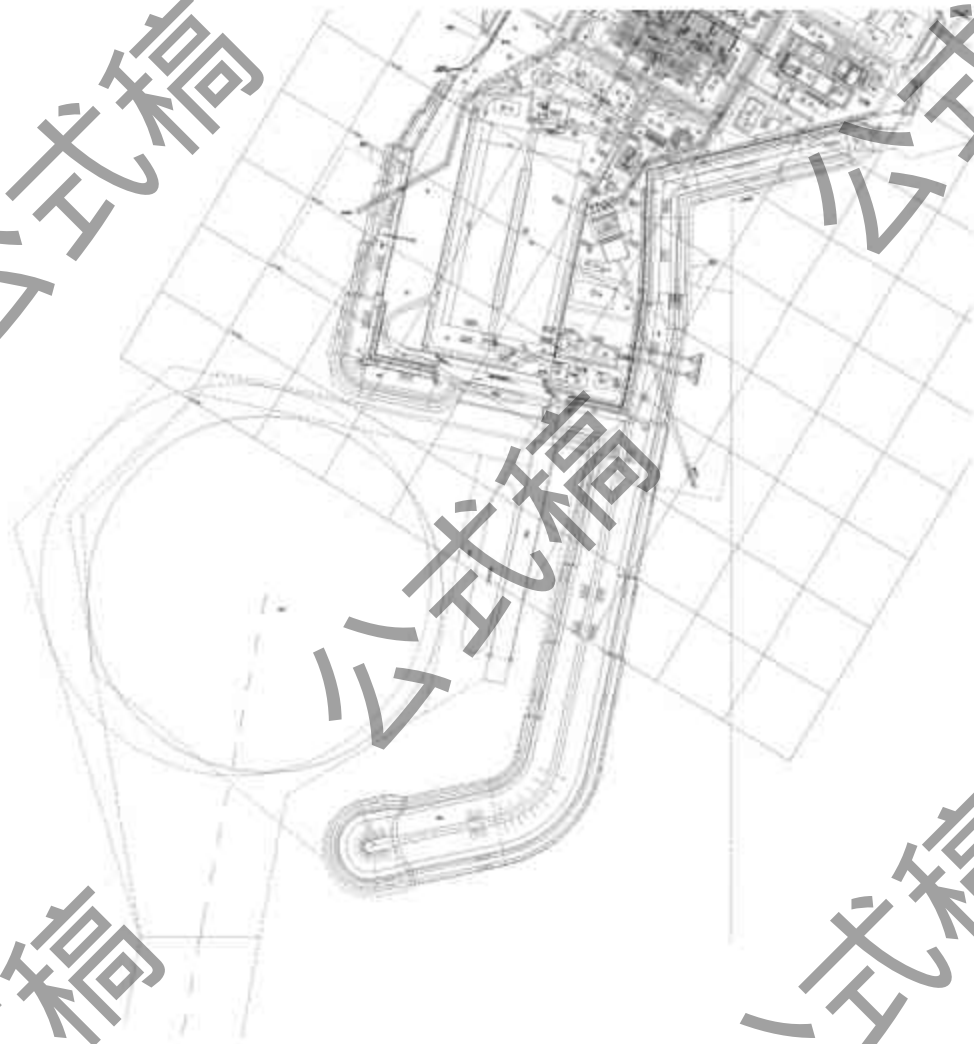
码头工程（防波堤、码头和港池）总平面布置图
